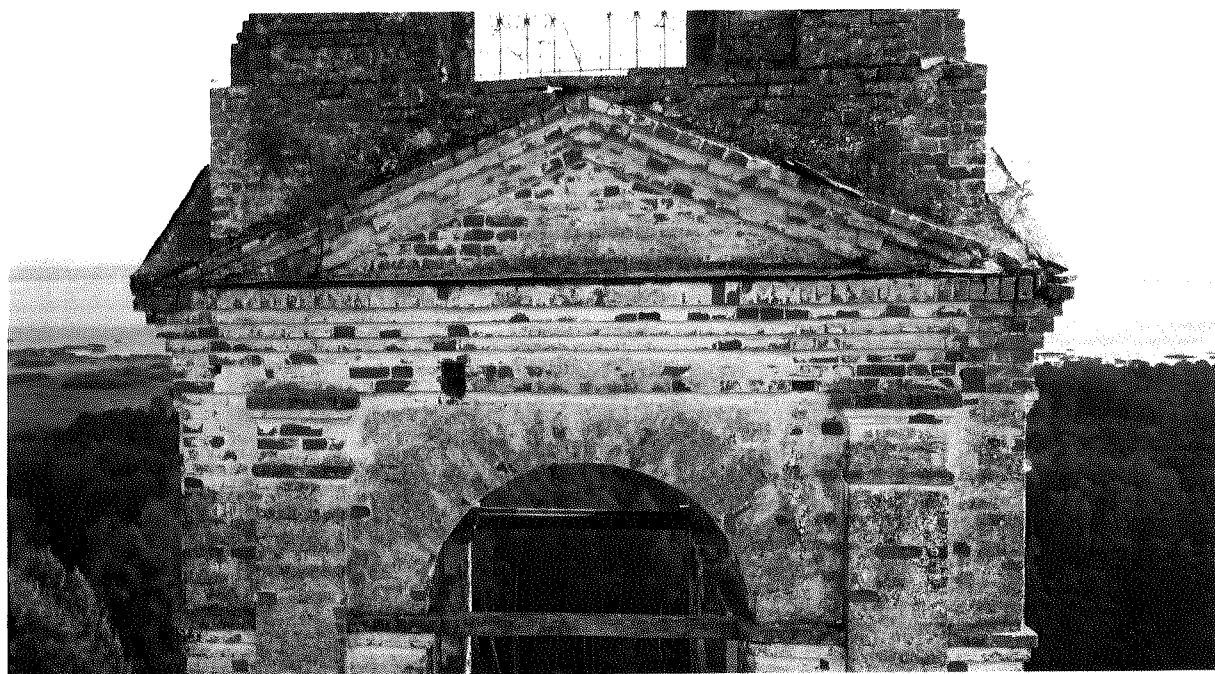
Колокольня. Второй ярус. Северный фасад. Фронтон
